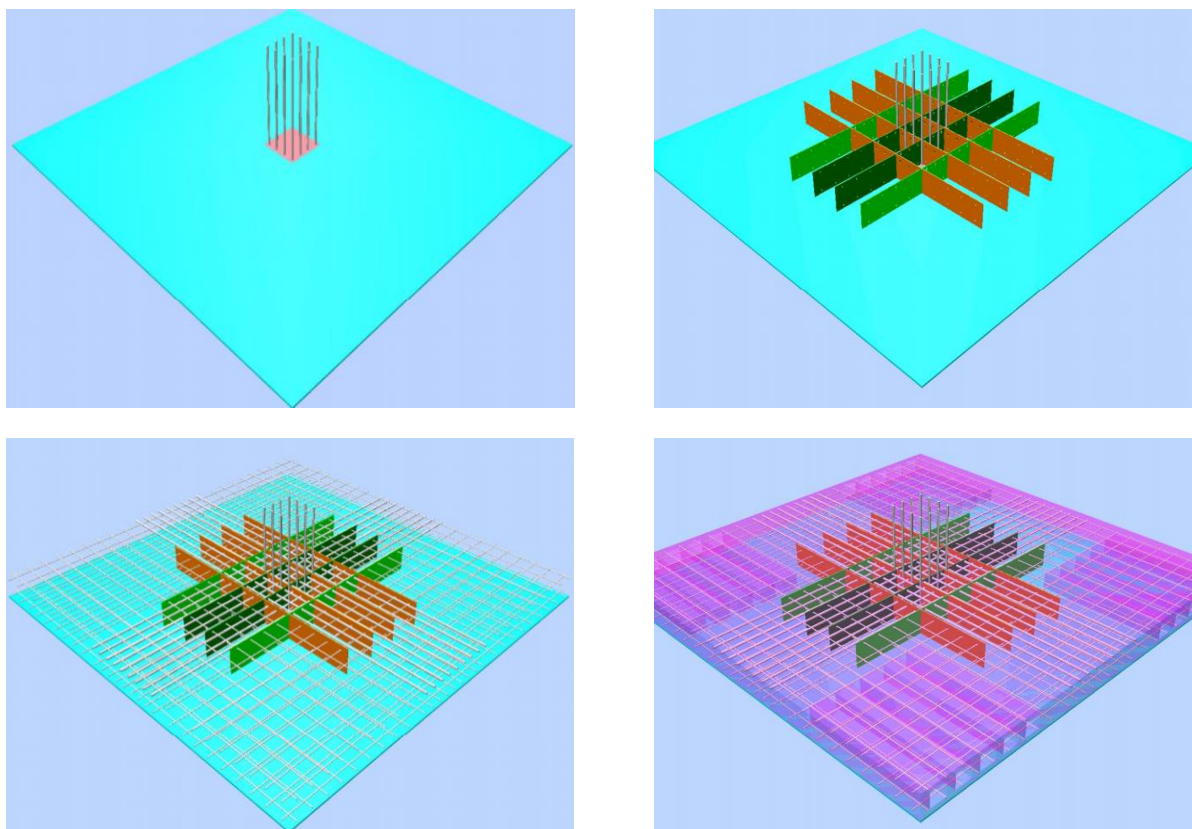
Принципиальная схема установки плитных сталежелезобетонных конструкций
